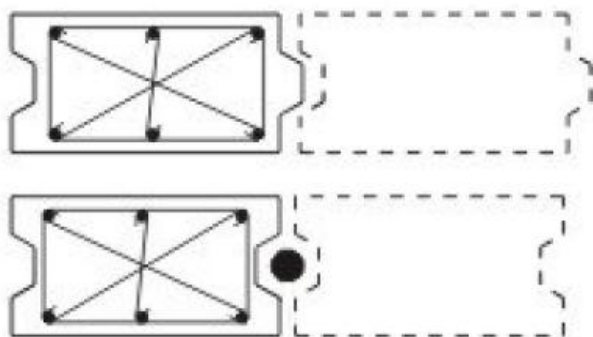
Exemple de palplanse din beton armat sau precomprimat și de tipuri de îmbinări
